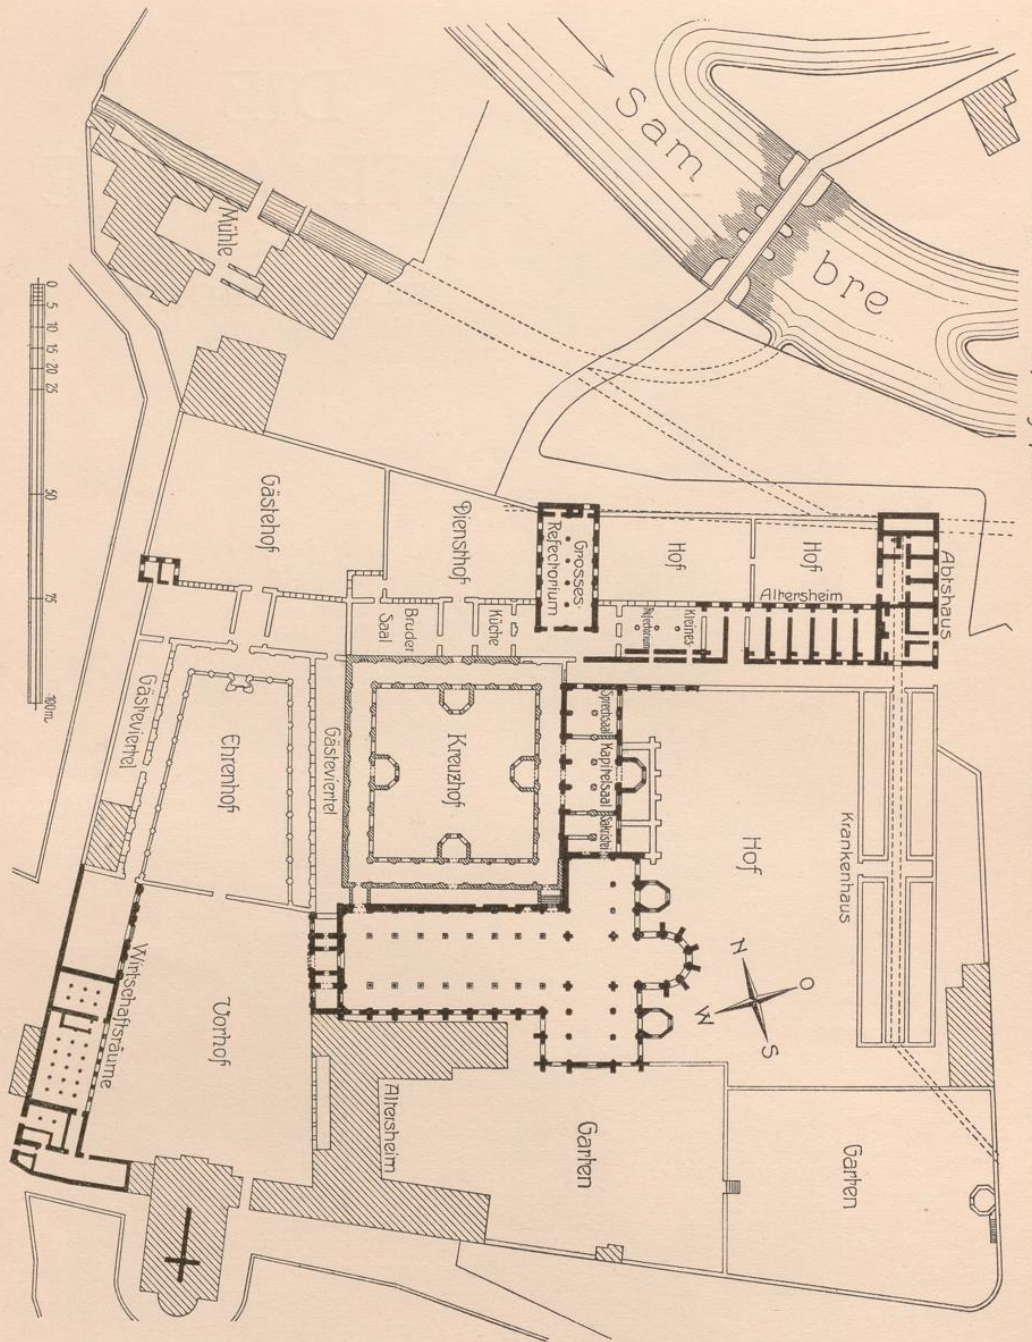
Lageplan, bearbeitet nach einem älteren Plane.
